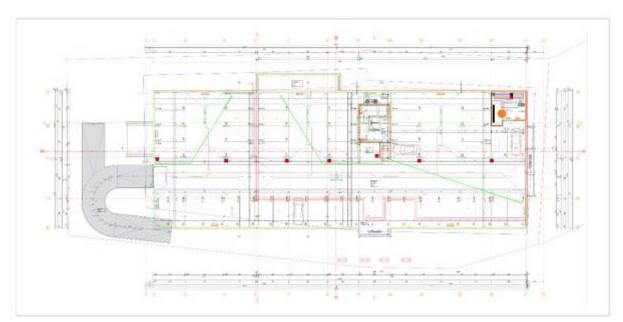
Grundriss Tiefgaragengeschoß (nicht maßstäblich)
